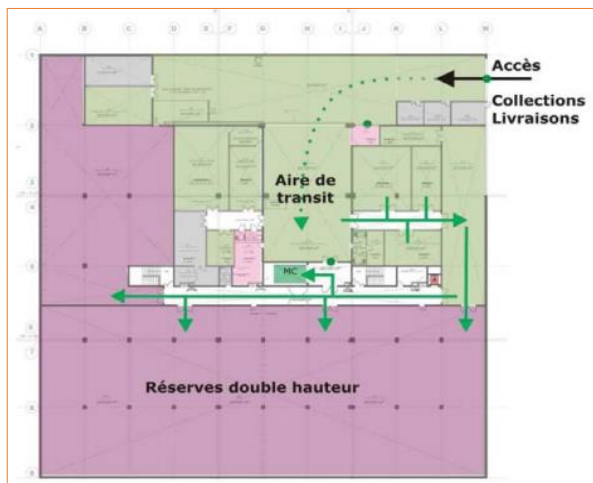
Plan R-2 de centre de conservation Marseille.
